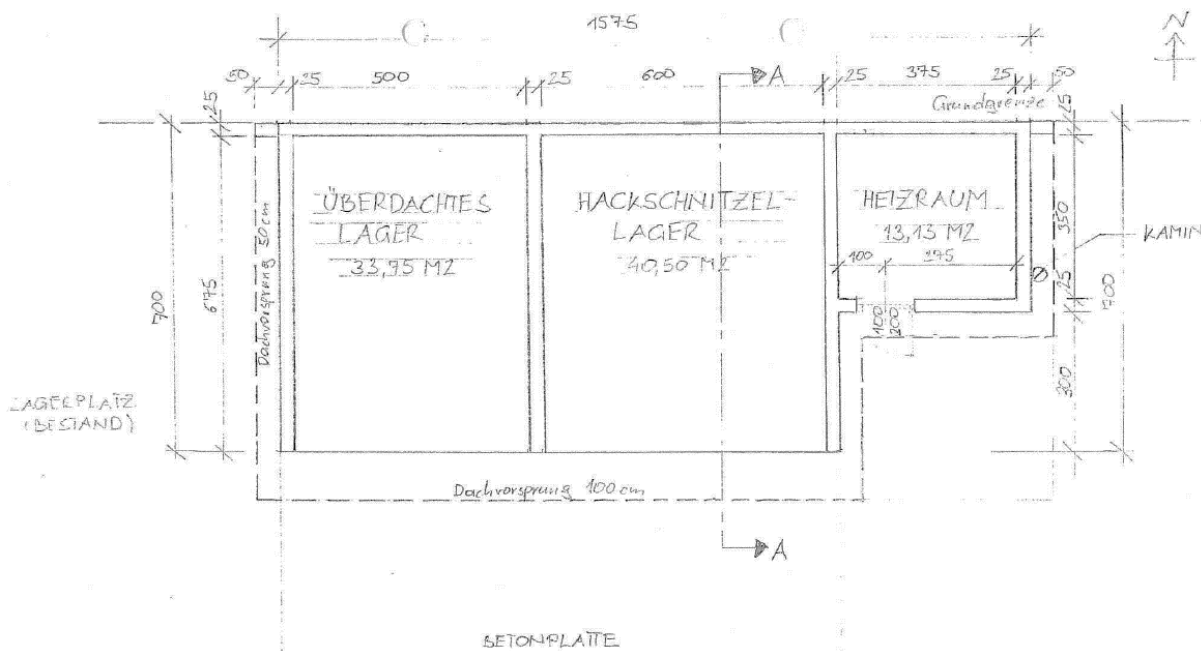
Grundriss der geplanten Hackschnitzelheizung am Gst. 1179/2.
